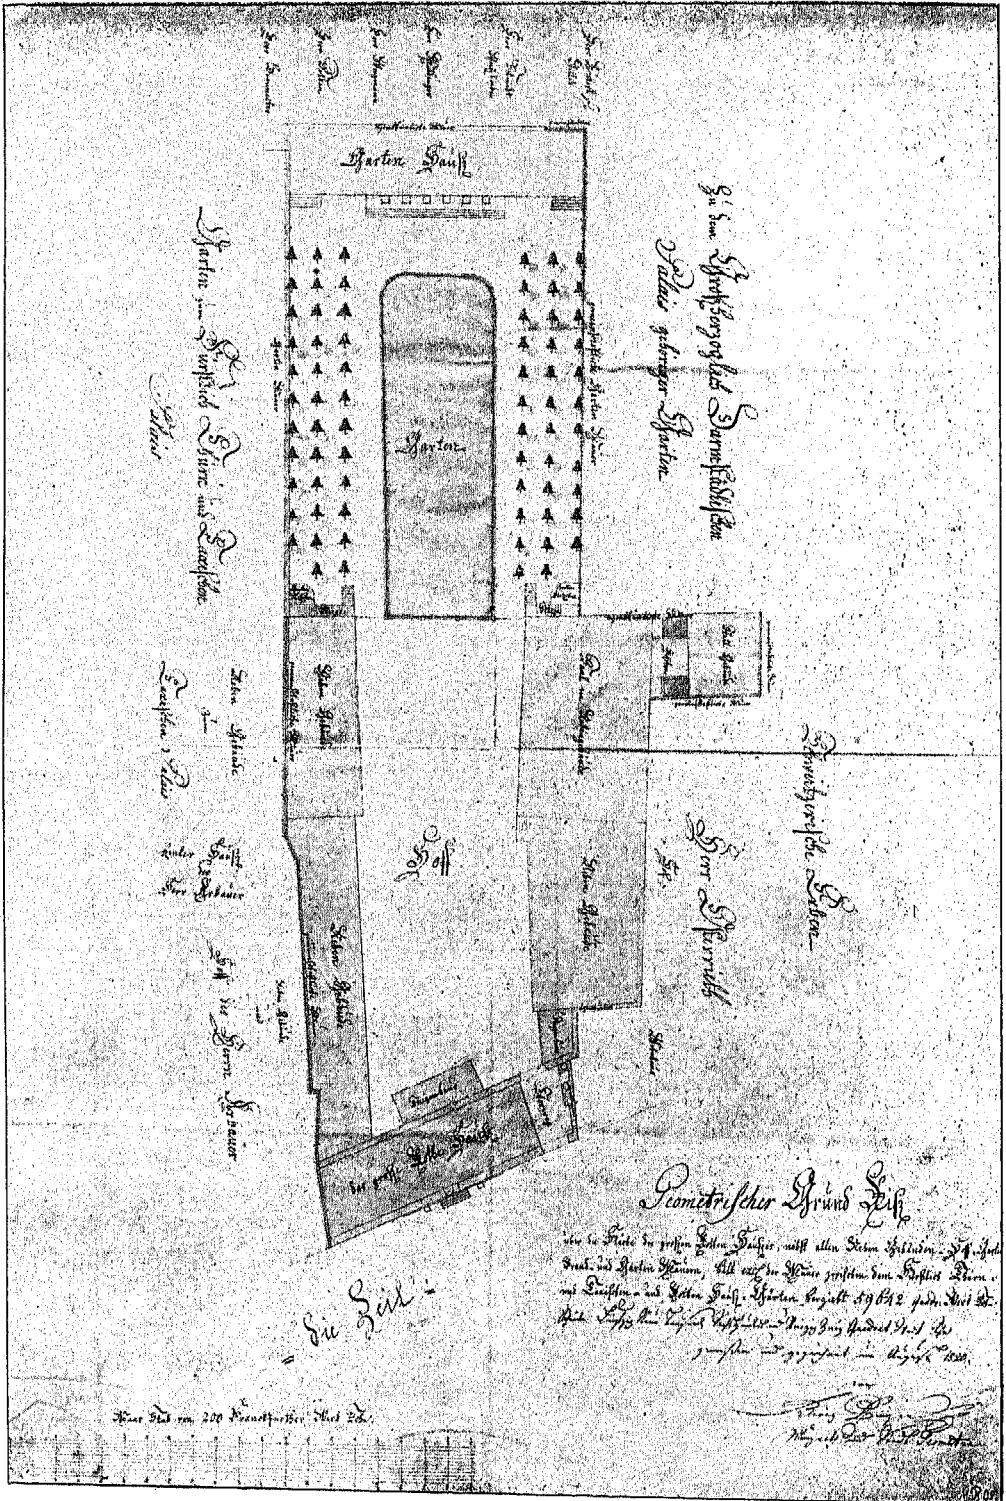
Rothes Haus; Grundriss aus dem Jahre 1820.
